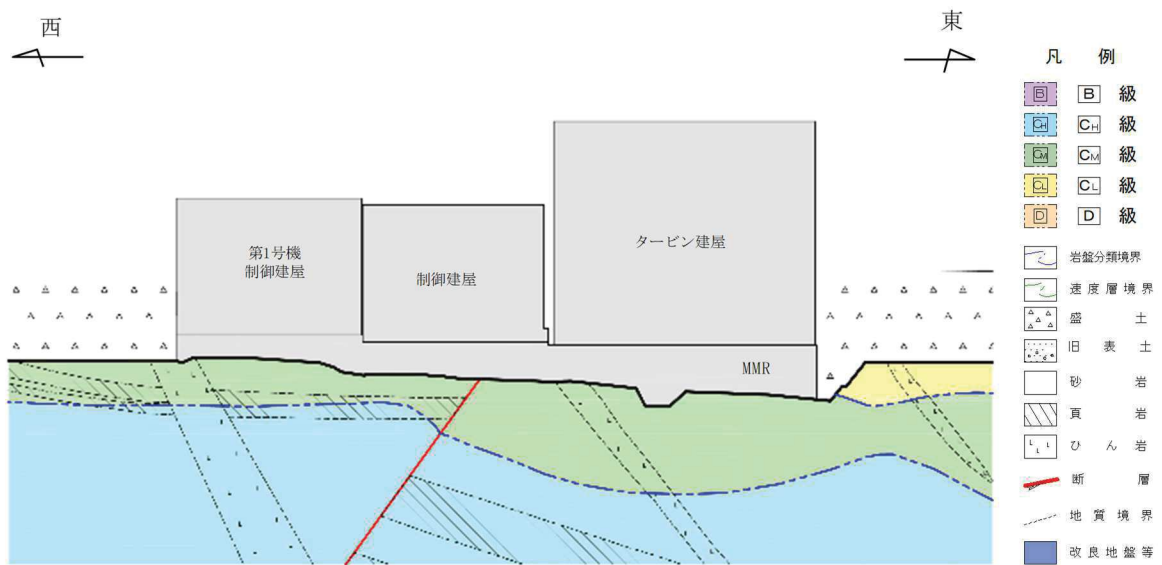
制御建屋の地質断面図 (③-③断面)
